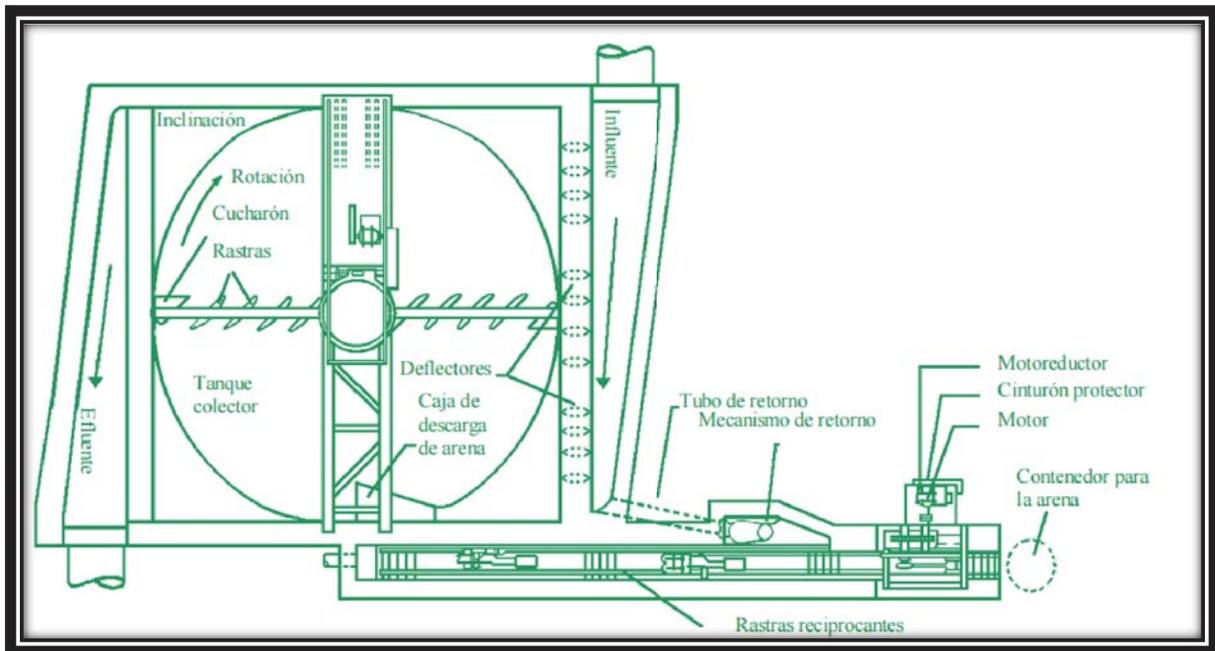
Vista en planta de un tanque desarenador. Fuente: Noyola et al, 2000
